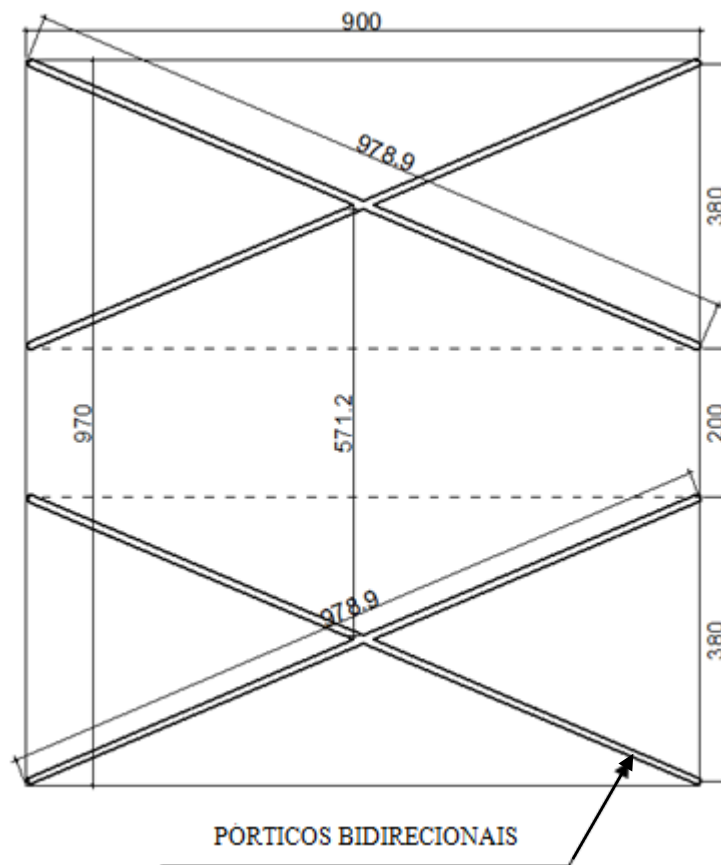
Planta do sistema estrutural com pórticos de estabilização bidirecionais
